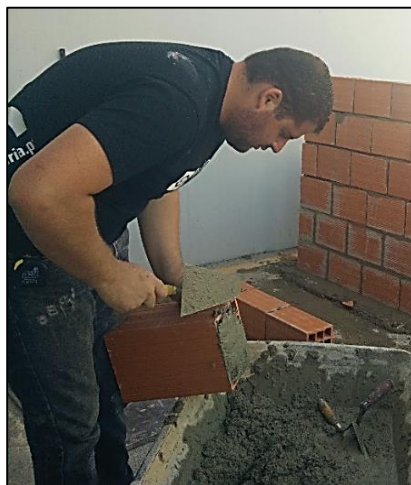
Aplicação de argamassa nas laterais dos tijolos
